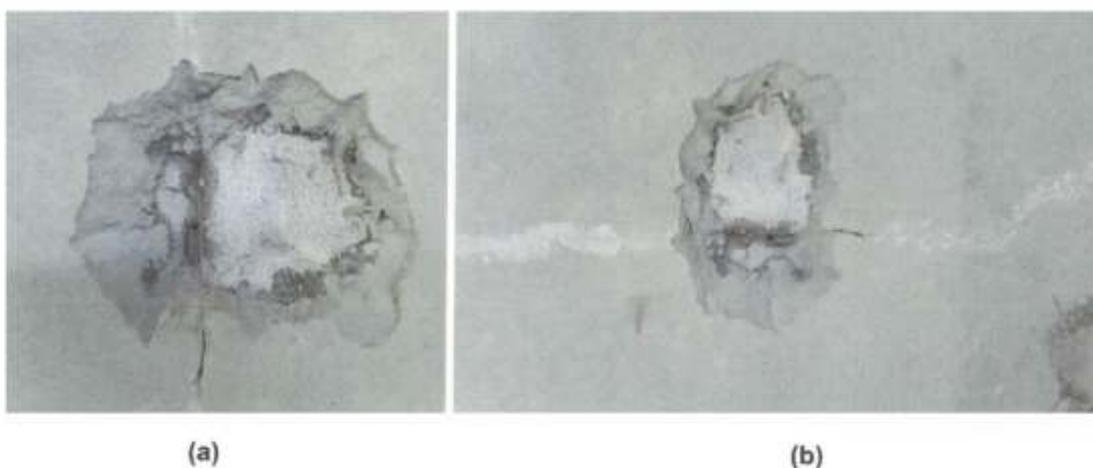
Fissura verticais e horizontais na face não exposta ao fogo.
